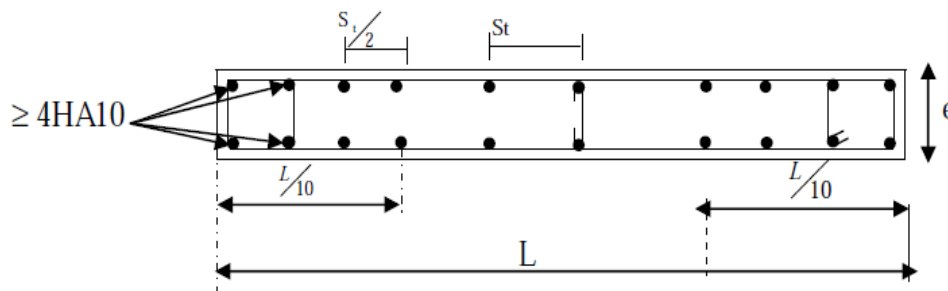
Disposition des armatures verticales dans les voiles.
